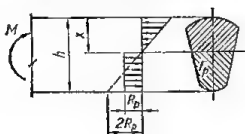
Схема расположения усилий и эпюра напряжений в поперечном сечении изгибаемого бетонного элемента.
